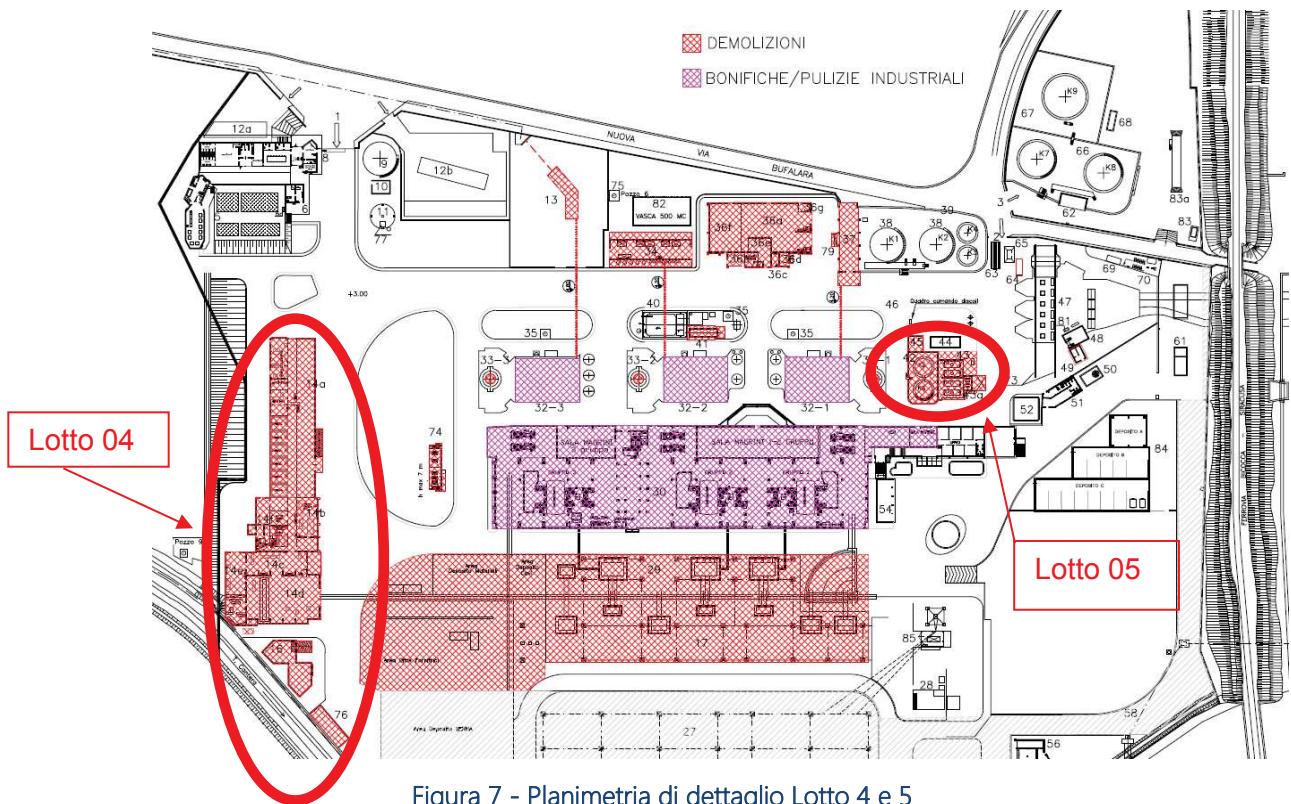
Planimetria di dettaglio Lotto 4 e 5
